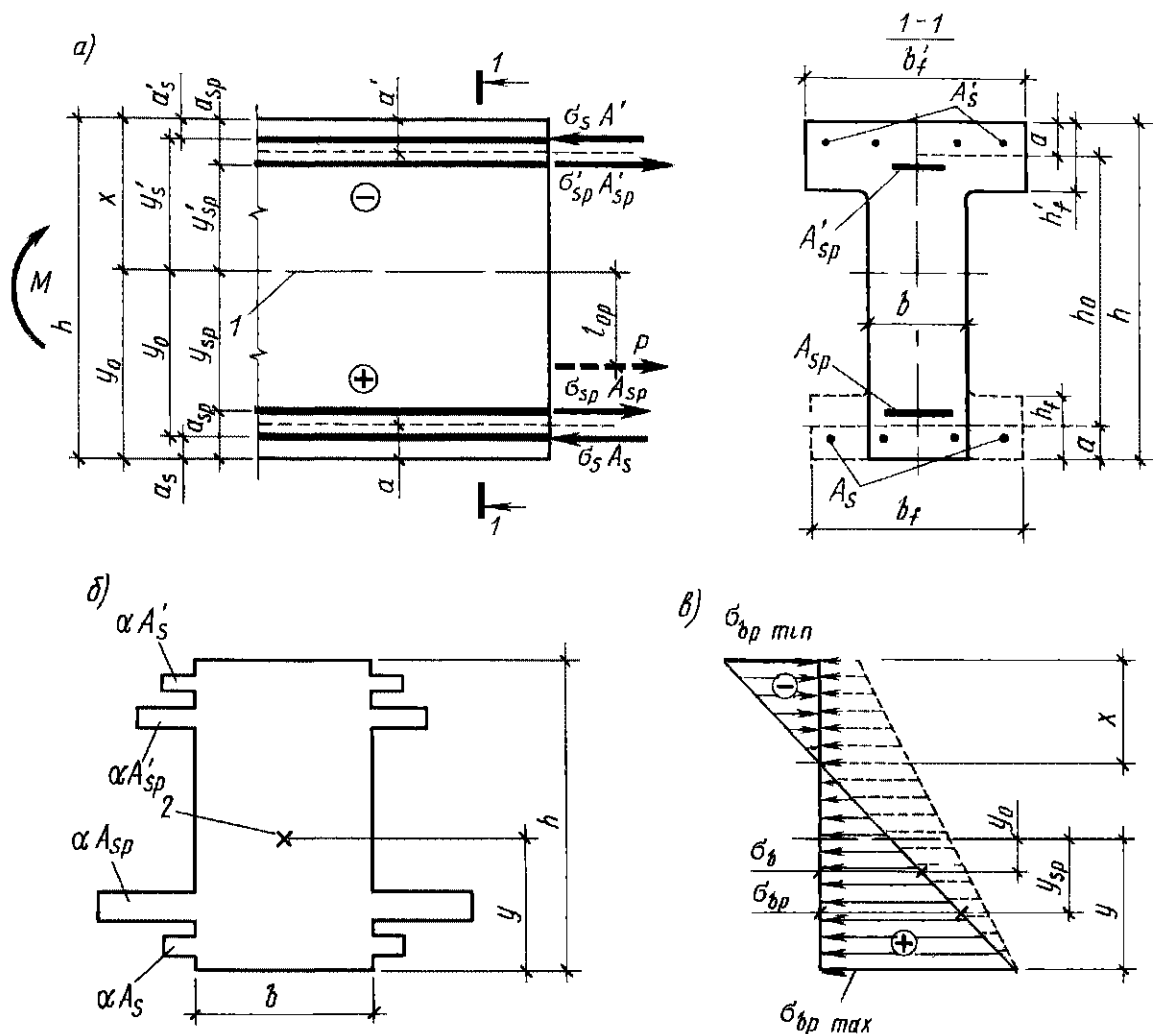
Фрагмент железобетонной предварительно напряженной балки
